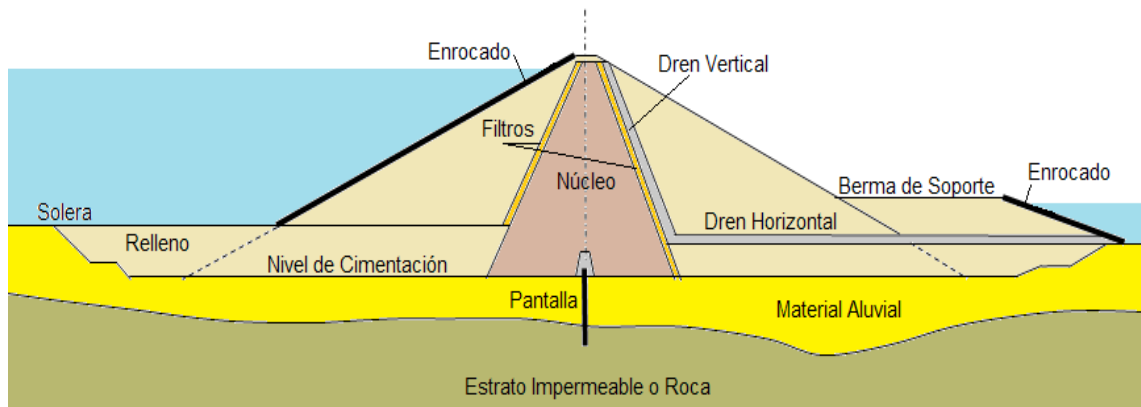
Perfil Típico de una presa cimentada sobre aluvial
